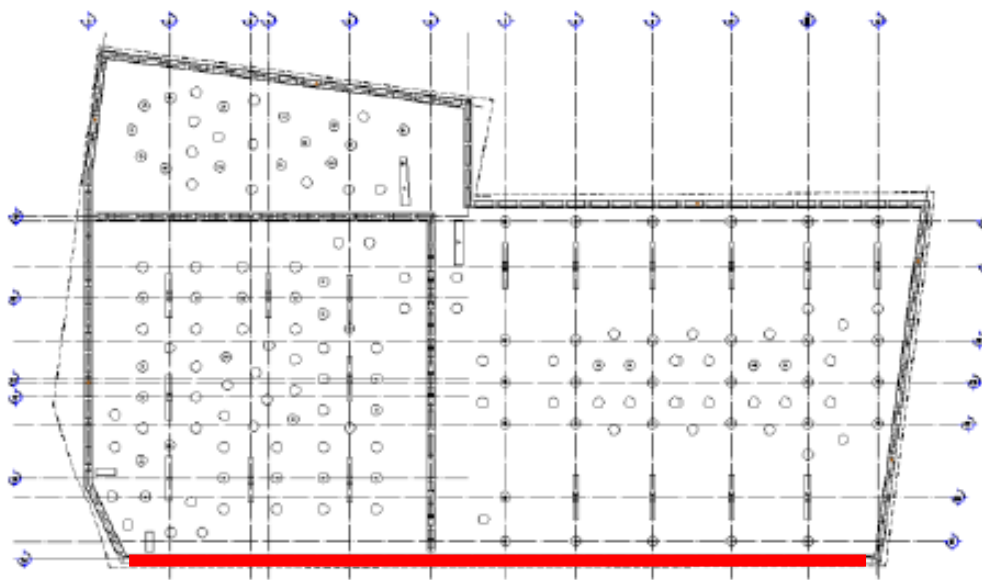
Ubicación en planta de las estructuras de contención de estudio (en rojo).
